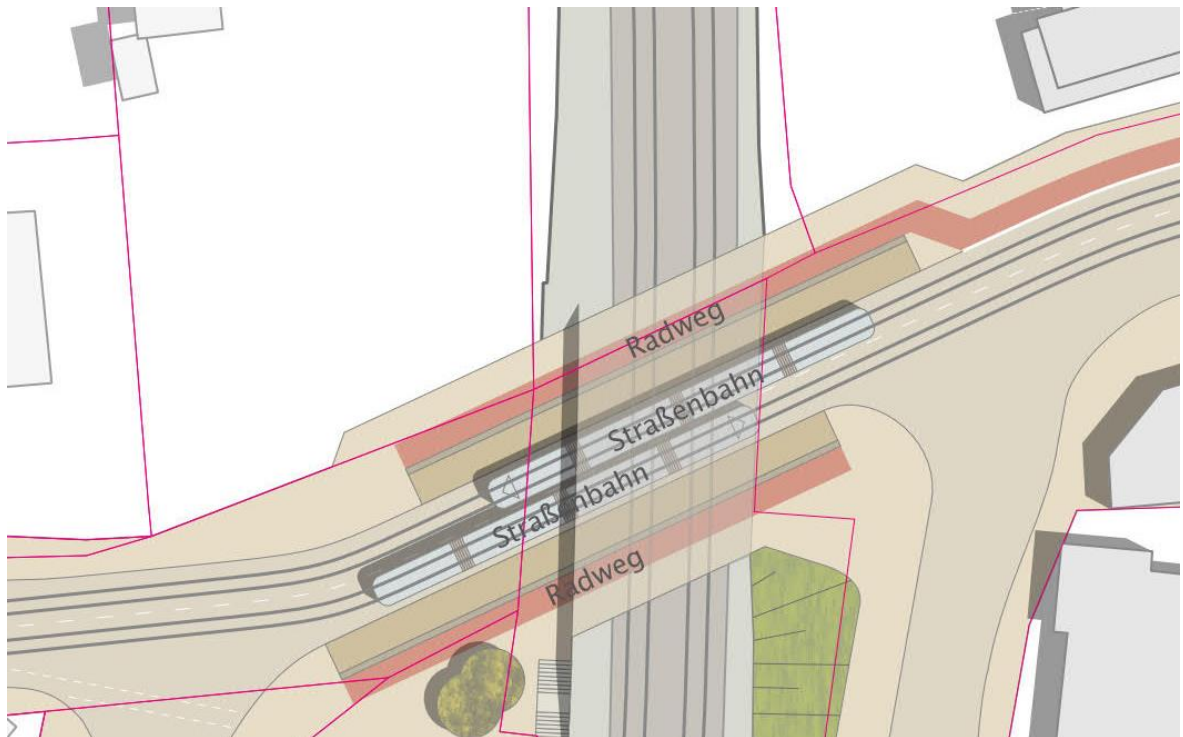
Lageplan Verkehrstrennung unter EÜ ohne Bahnsteigverlängerung
